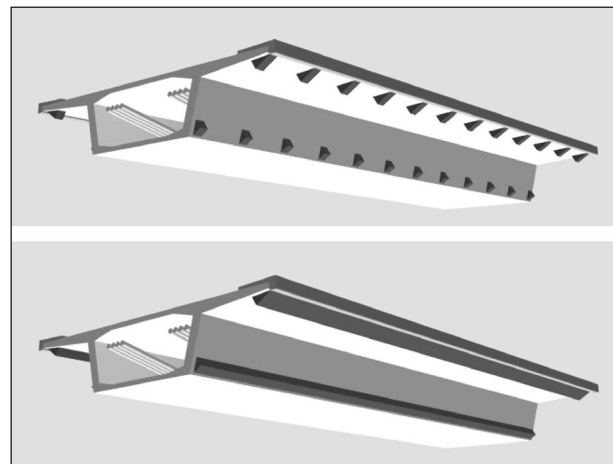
Anpassung der Geometrie – Ursprungsbauwerk mit Ergänzungsfachwerk (oben) und rechtwinklige Ausführung (unten)
